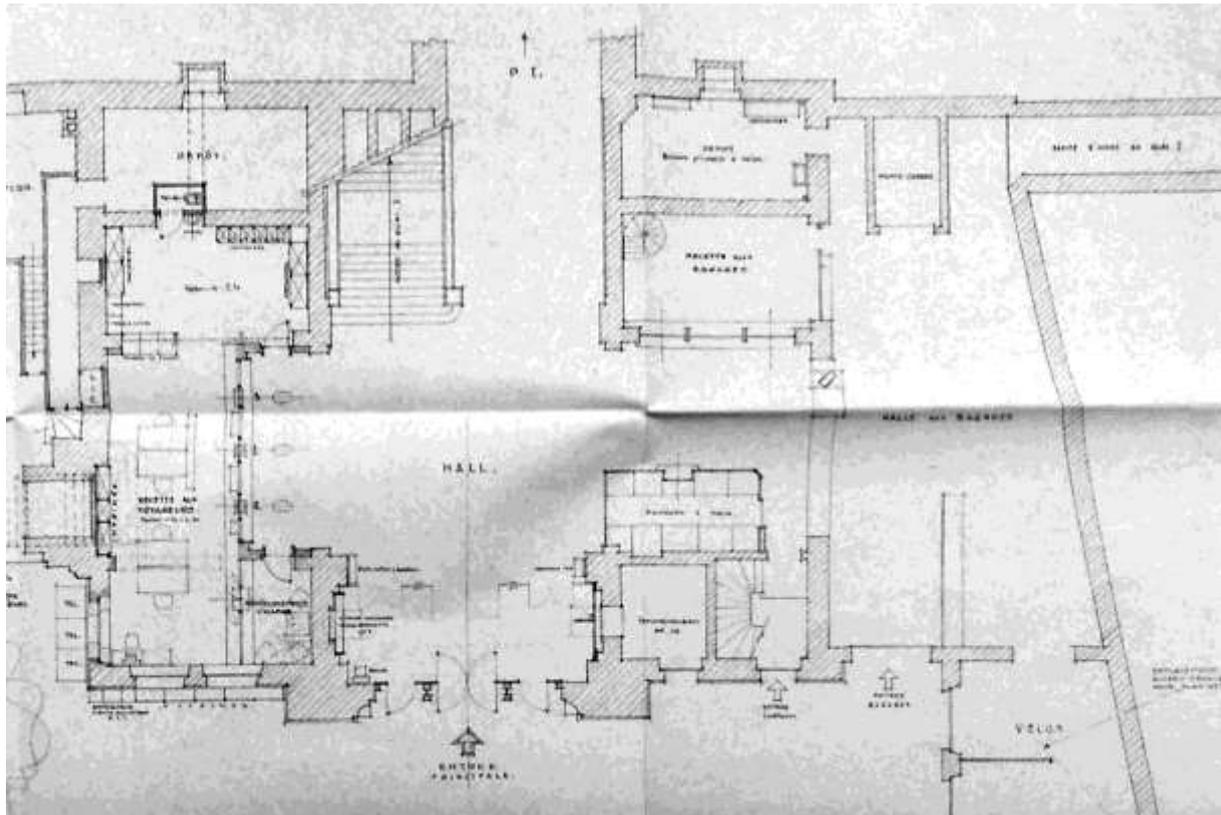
Rez-de-chaussée inférieur, plan, CFF Division des travaux Section des bâtiments, 26.8.1950 (CFF Lausanne Infrastructures, 356/3/Vevey/1912/2).
